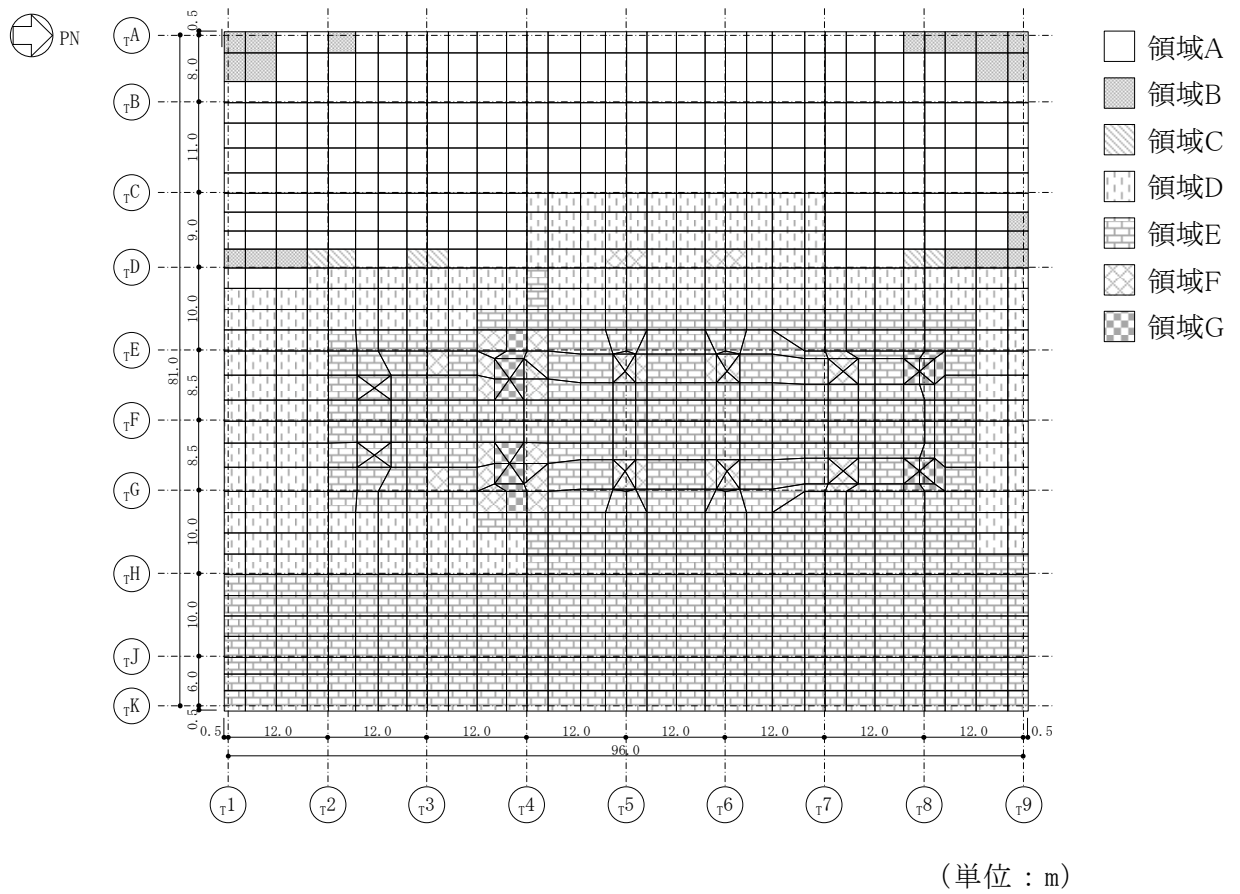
基礎スラブの配筋領域図 (EW 方向, 下ば筋)
